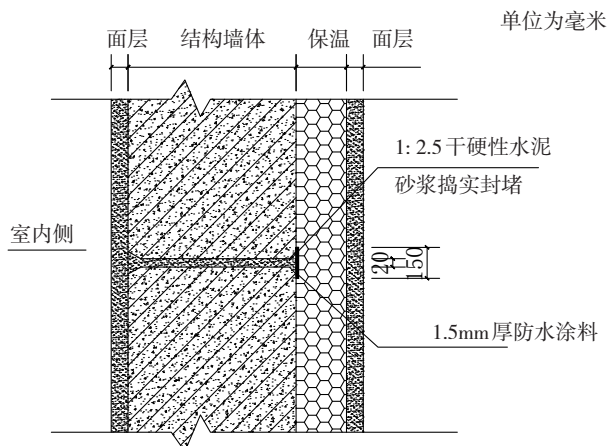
混凝土对拉螺栓孔洞封堵
